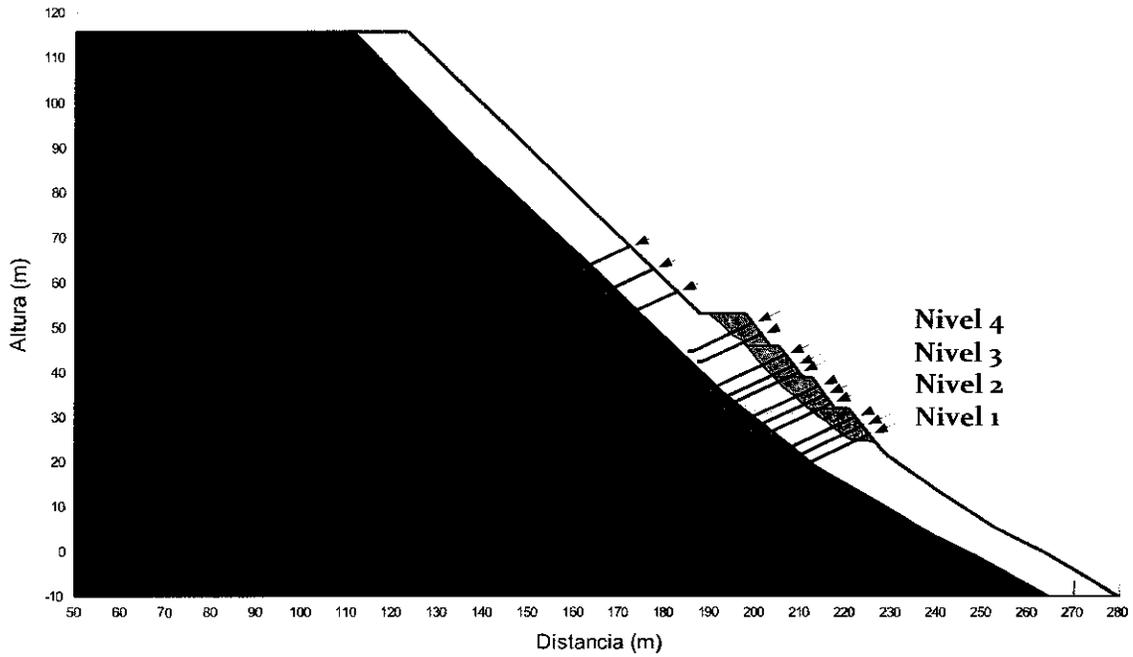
Geometría del relleno y refuerzo recomendado en Sector 2.
